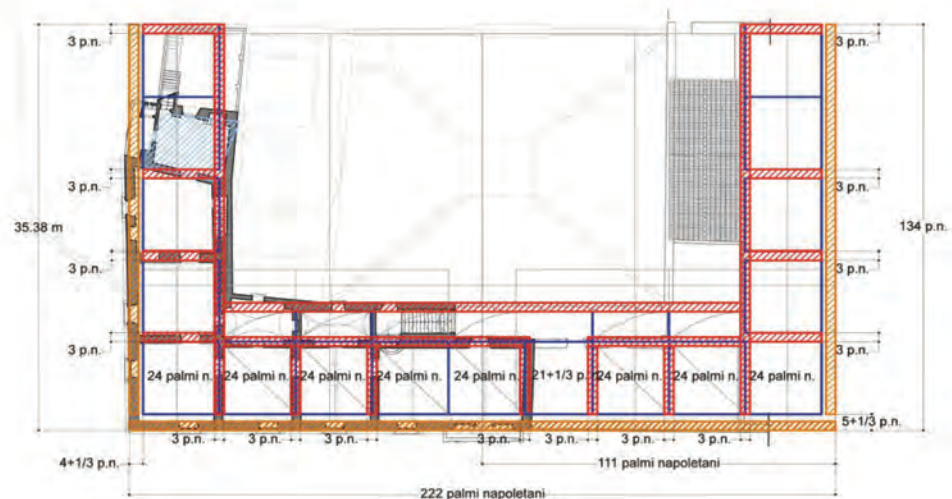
Sovrapposizione dello schema geometrico alla pianta del piano primo.
